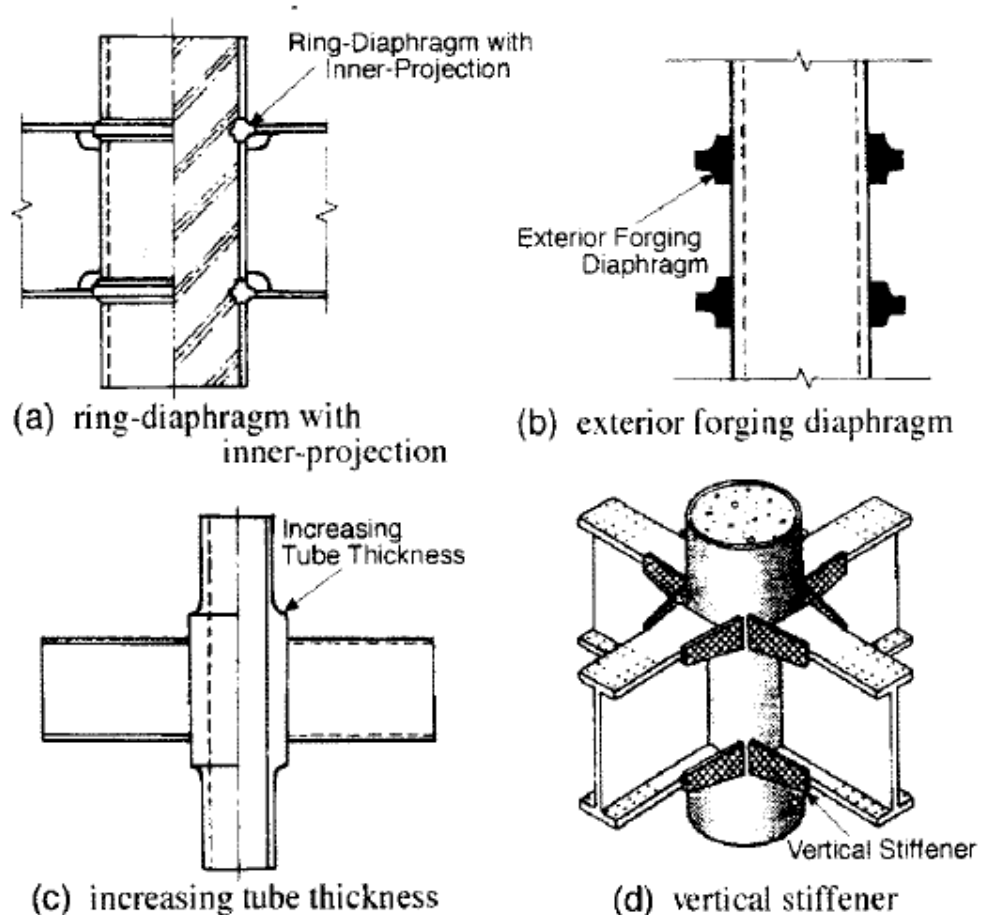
Detalles recientemente desarrollados de conexión de acero viga-columna circular. [18]
